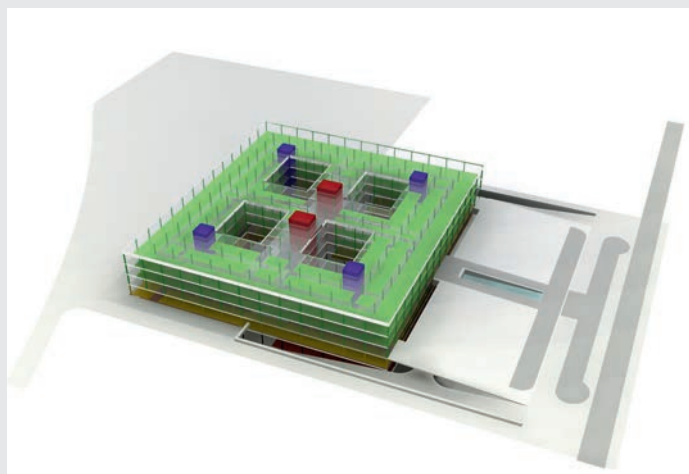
Poznań, pediatria – 1. piętro, wzdłuż elewacji 240 łóżek w pokojach 2-osobowych z łazienkami, od wnętrza przy patiach pomieszczenia dla personelu i gabinety zabiegowe, w ciemnym trakcie wewnętrznym pomieszczenia usługowe w podziale zgodnym z programem. W centrum planu pion komunikacyjny, 12 dźwigów, a w ramionach przylegających do niego 16 pokoi hotelowych dla matek dzieci. Architekt: Artur Słabiak
